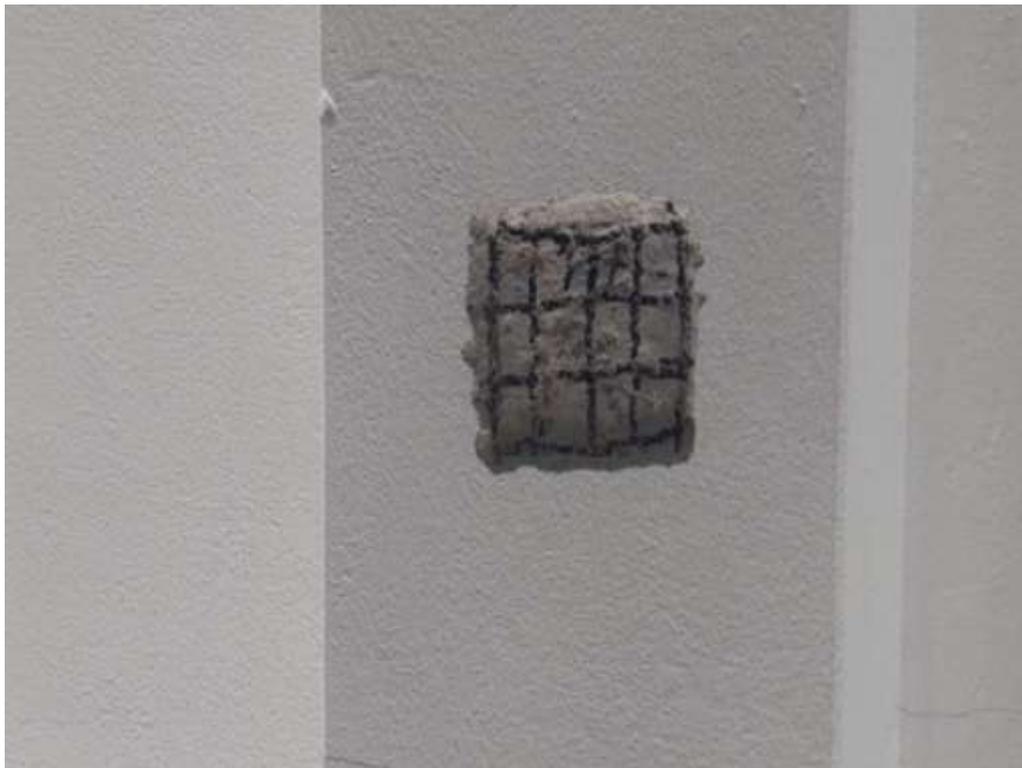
Retirando el recubrimiento en uno de los elementos estructurales (columna) para la posterior prueba de esclerometría.
